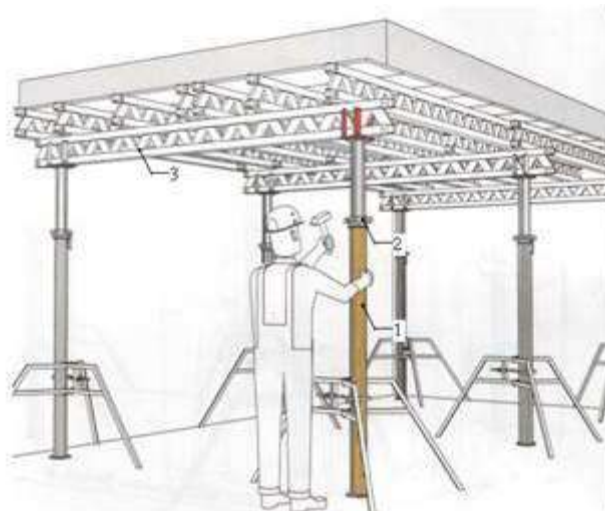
Опускание настила опалубки: 1-основная стойка;2-регулирующая гайка; 3-продольная балка
